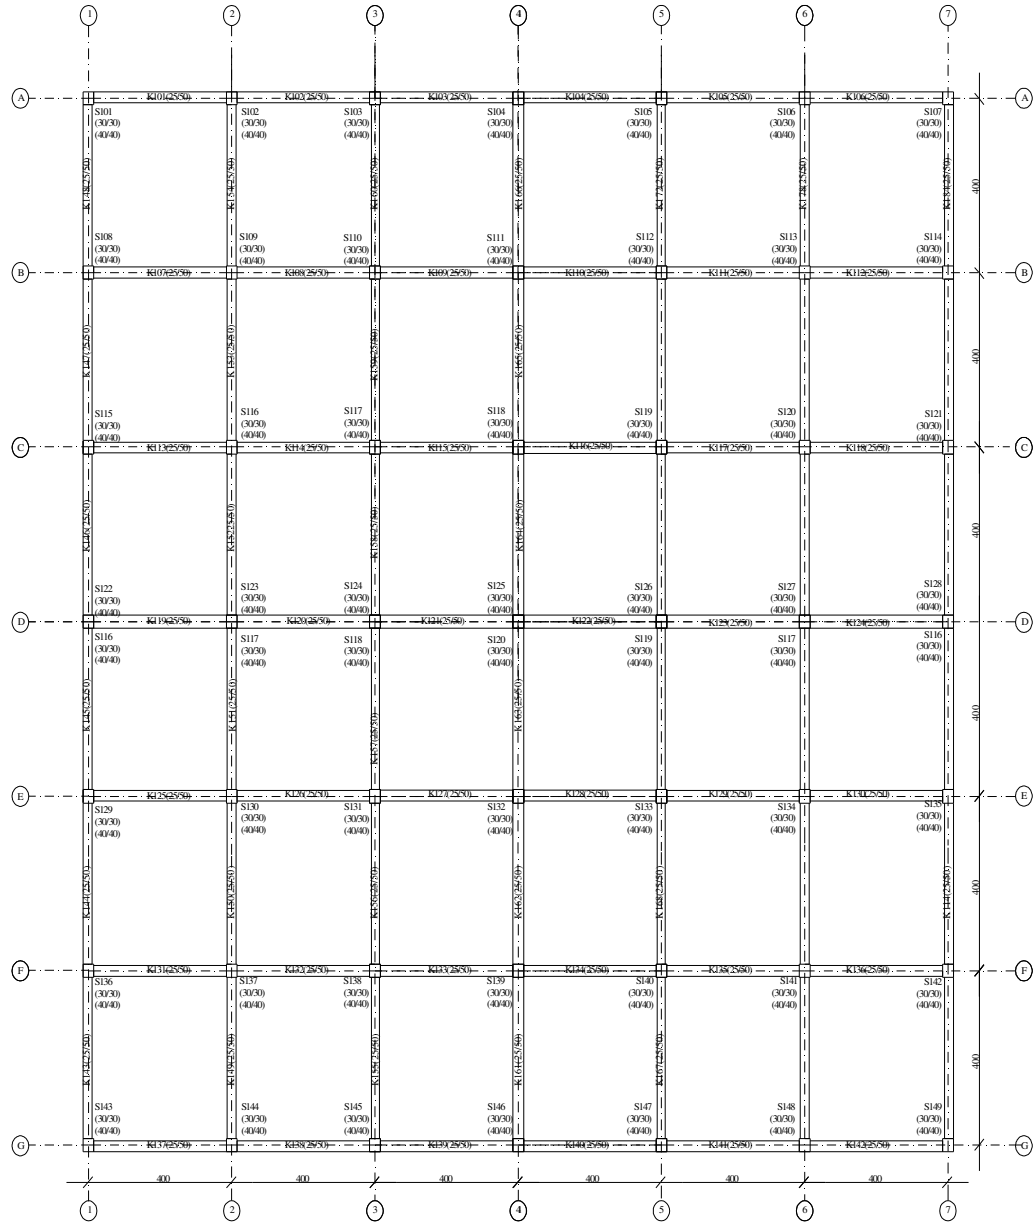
Tip 2 yapısına ait kat kalıp planı
